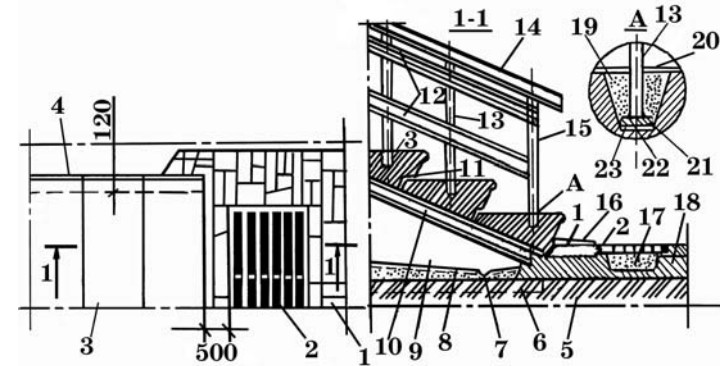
Пример стыкования типовых конструкций ступеней входа с площадкой перед входом по грунту: 1 — покрытие площадки входа керамической плиткой (обломками камня, гранита, мрамора и т. п.); 2 — металлическая решетка размером 50x90 см над углублением для сбора воды, мусора и грязи с подошв; 3 — ступени; 4 — кирпичная стенка (торцевая); 5 — грунт основания; 6 — утрамбованный грунт; 7 — сточный желоб; 8 — отмостка; 9 — кирпичная стенка (торцевая); 10 — наклонная балка (металлическая, железобетонная); 11 — стык, зачеканенный цементным раствором; 12 — промежуточные планки (декоративные); 13 — стойка ограждения (крепить по месту в отверстие ступени или к торцам ступеней металлическими деталями болтового соединения либо сваркой; поверхность накладных проступей зажелезнить); 14 — поручень ограждения (деревянный, металлический); 15 — крайняя стойка ограждения; 16 — цементно-песчаная стяжка с уклоном; 17 — выемка под металлической решеткой; 18, 23 — цементный раствор; 19 — цементно-песчаный раствор; 20 — поверхность зажелезненной ступени; 21 — металлическая пятка; 22 — сварной шов.
